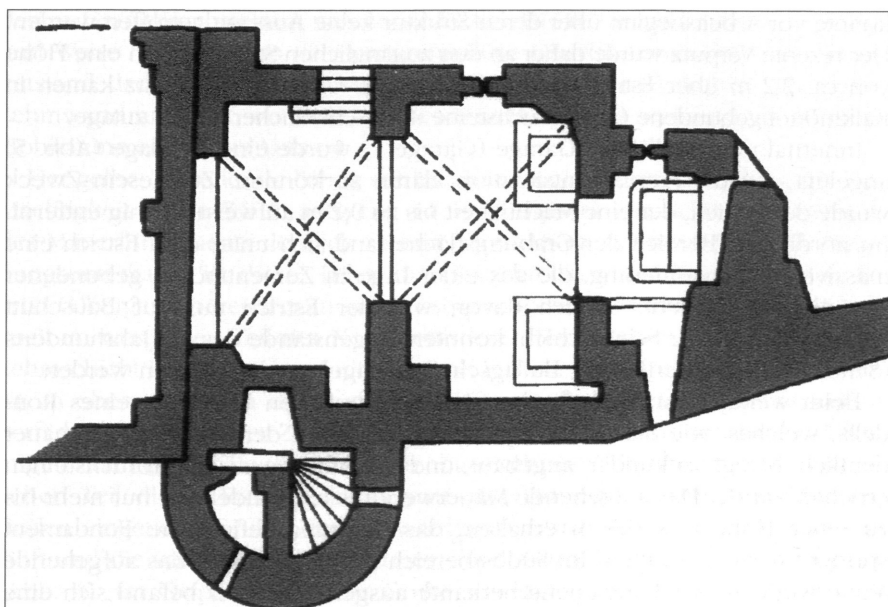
Burgkapelle und Rondell nach dem Plan von J. B. Lamprecht.
